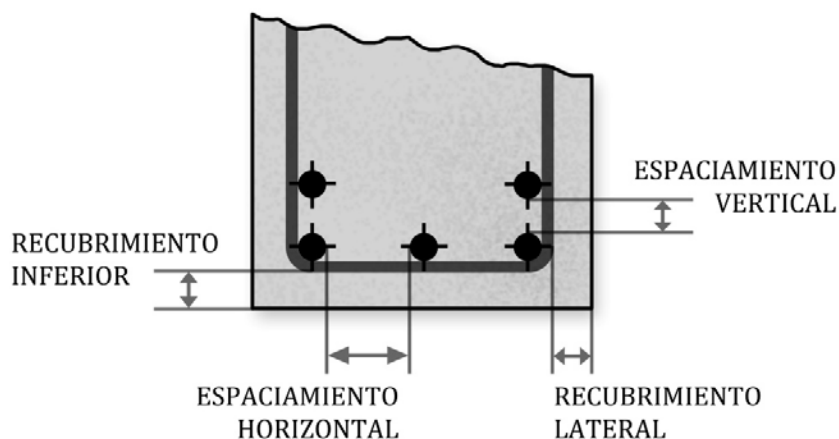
,6 : Espaciamiento entre barras y recubrimiento en vigas
